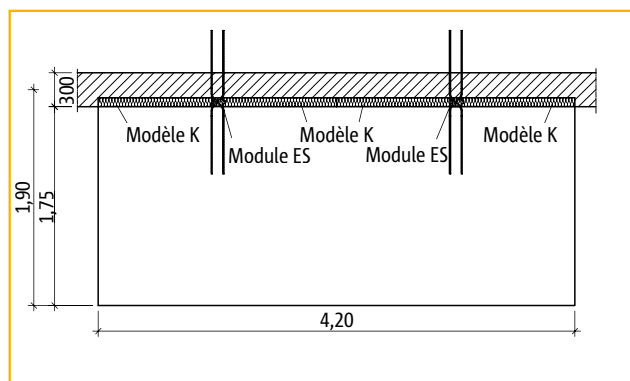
disposition des éléments du rupteur Rutherma® - vue en plan
